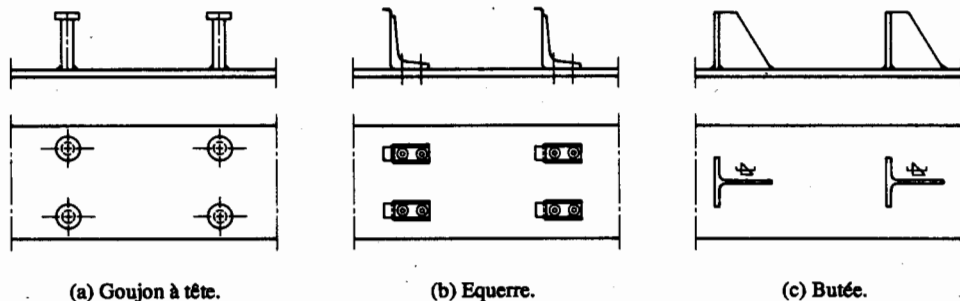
Exemples de connecteurs utilisés dans les sections mixtes acier-béton.
